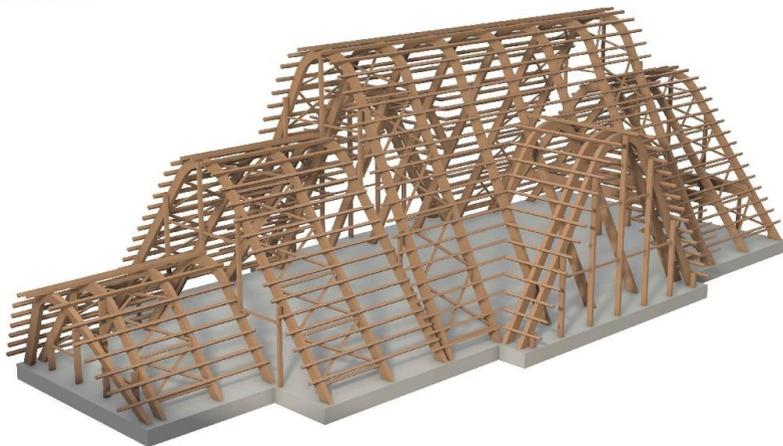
Общий вид основных несущих конструкций покрытия
